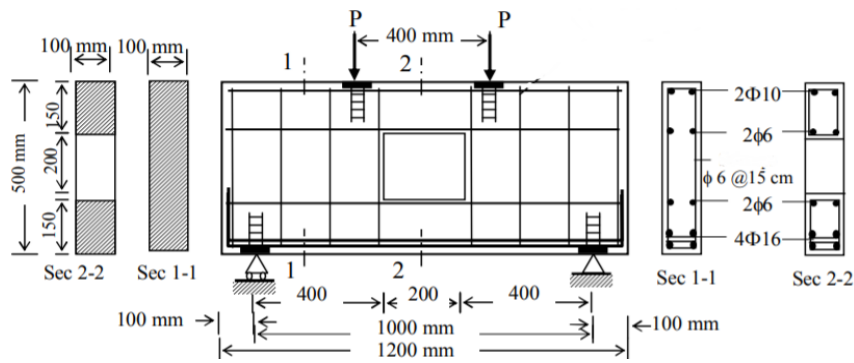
Geometria, carregamento e armaduras da viga-parede (HEIZA *et al.*,2012)
